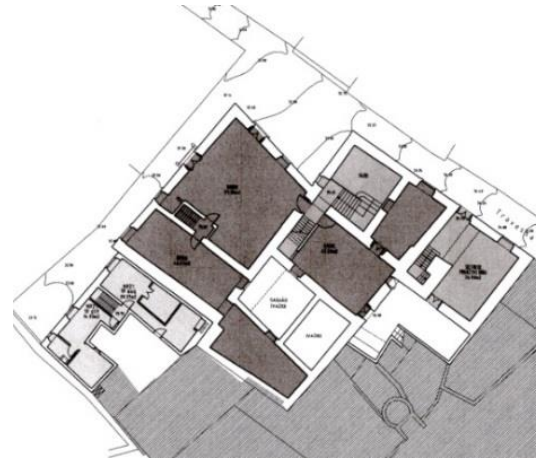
Planta do piso 2, do conjunto da travessa dos Lagares.
